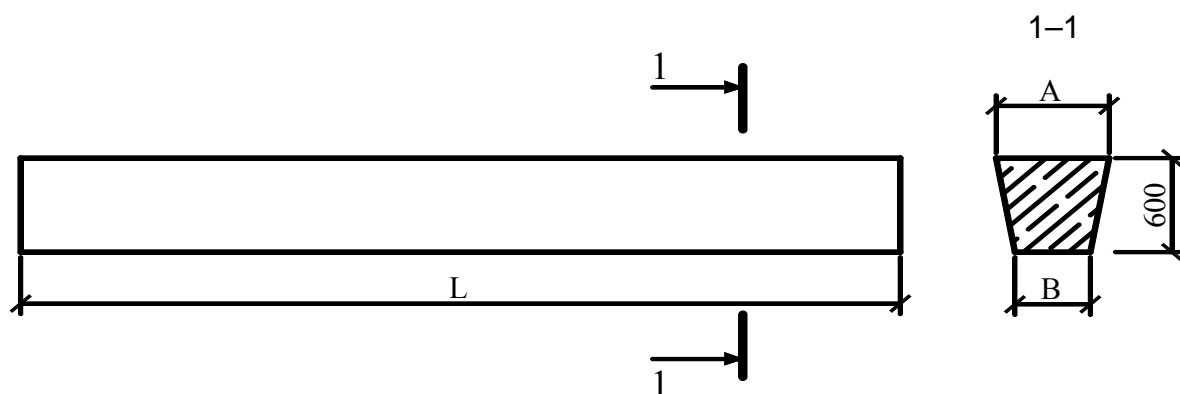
Фундаментные балки для панельных стен с кирпичным цоколем высотой до 2,4 м для зданий с шагом колонн 12 м
